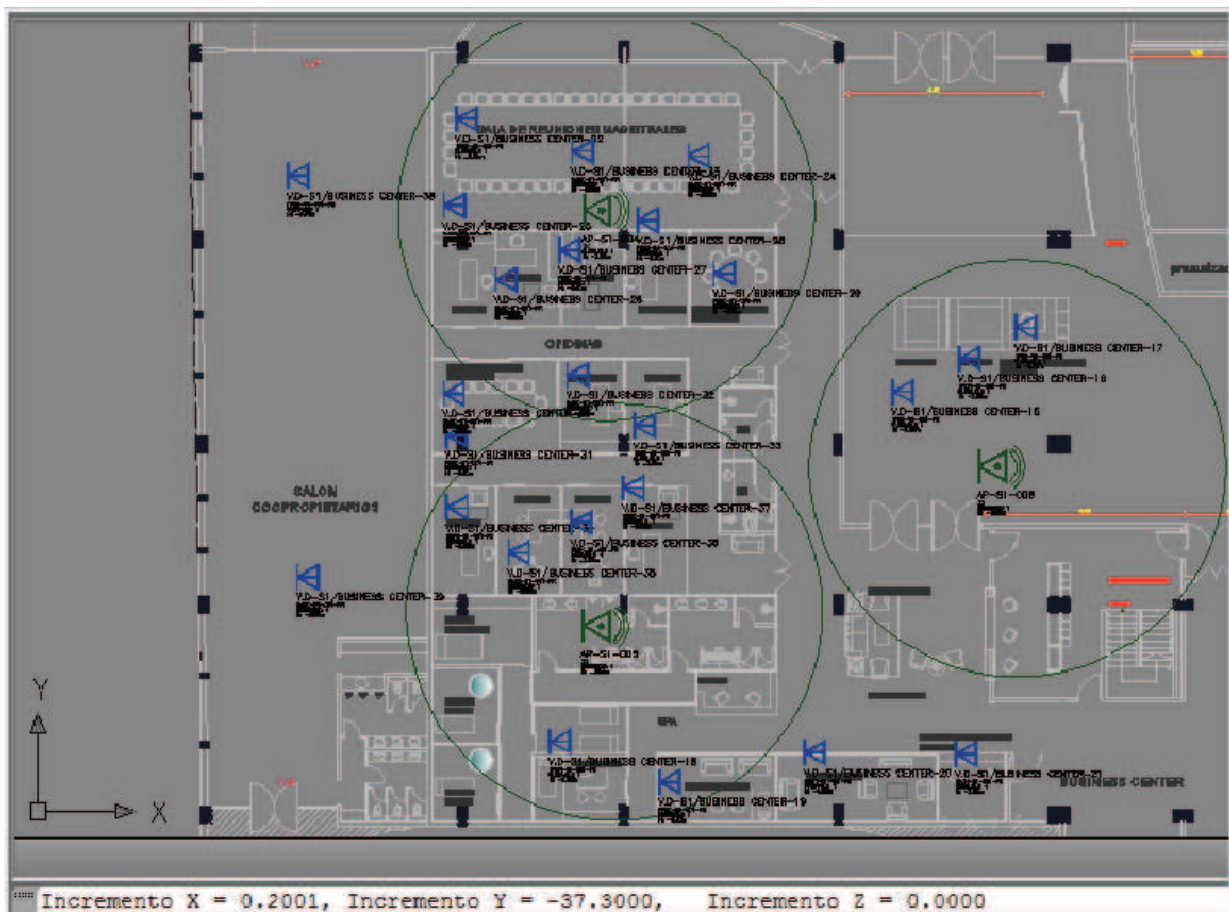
Planta de Referencia para zonas cerradas⁷⁹
